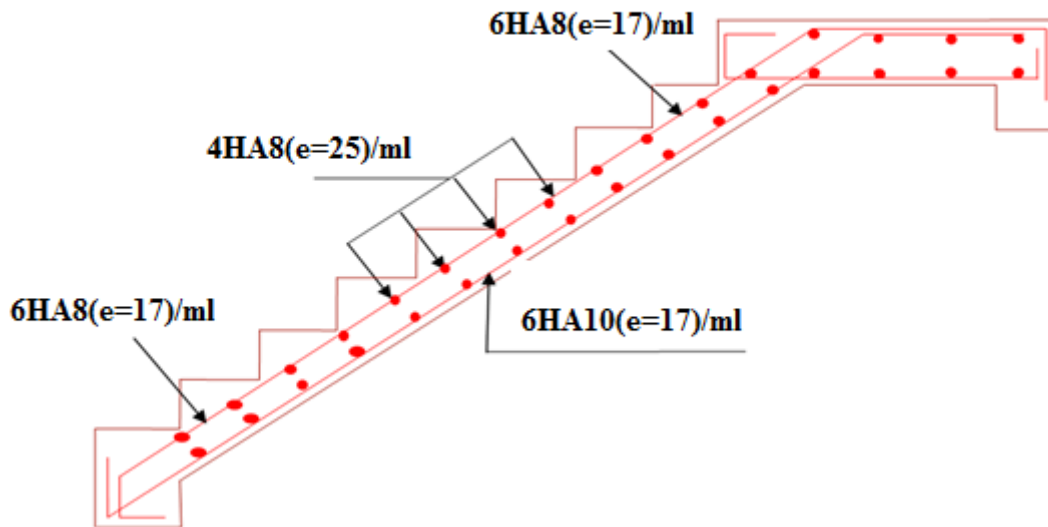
ferrailage de l'escalier d'entre sol 2
